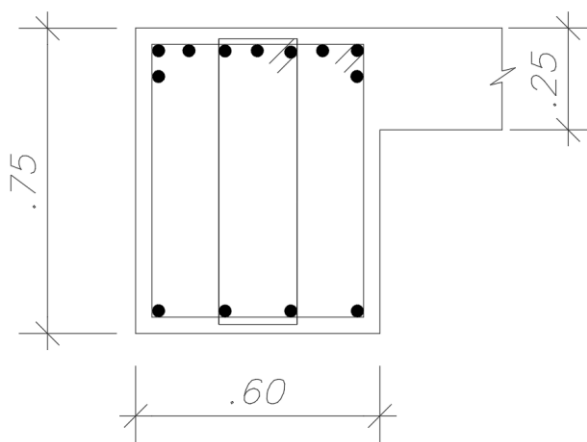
Sección transversal de viga V-05 (0.60x0.75) M
